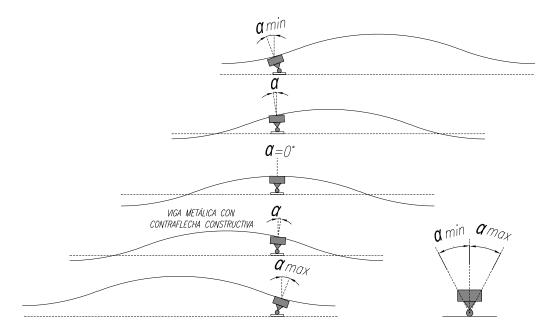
Interacción entre apoyo deslizante y viga metálica con contraflecha
